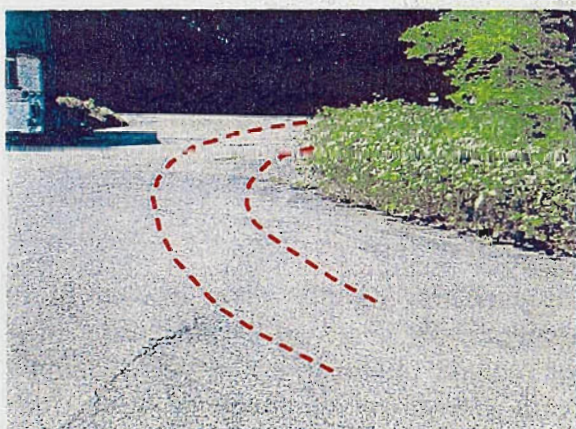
Affaissement de terrain se traduisant par des fissures dans le sol et sur un bâtiment.
